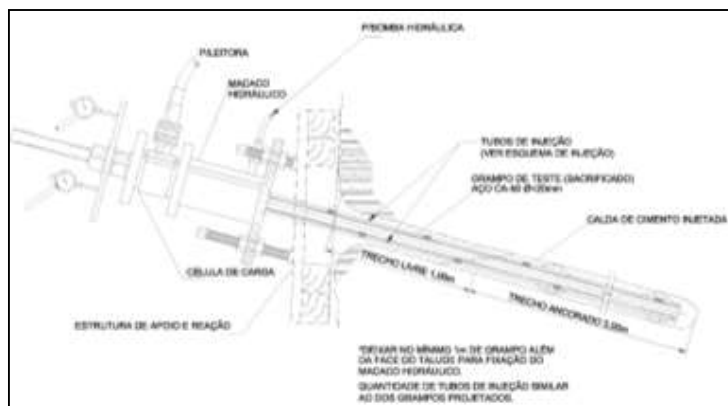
Croqui do arranjo do ensaio de arrancamento
